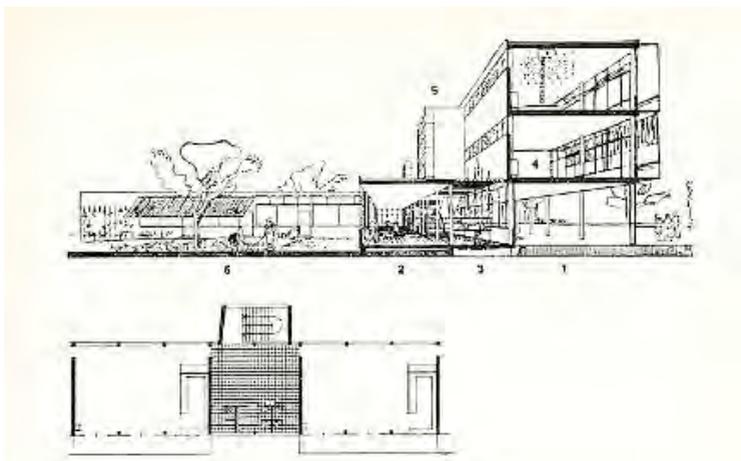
Sección y planta de la unidad de dos aulas con escalera. Proyecto Escuela Kappeli en Alstetten (1932).
